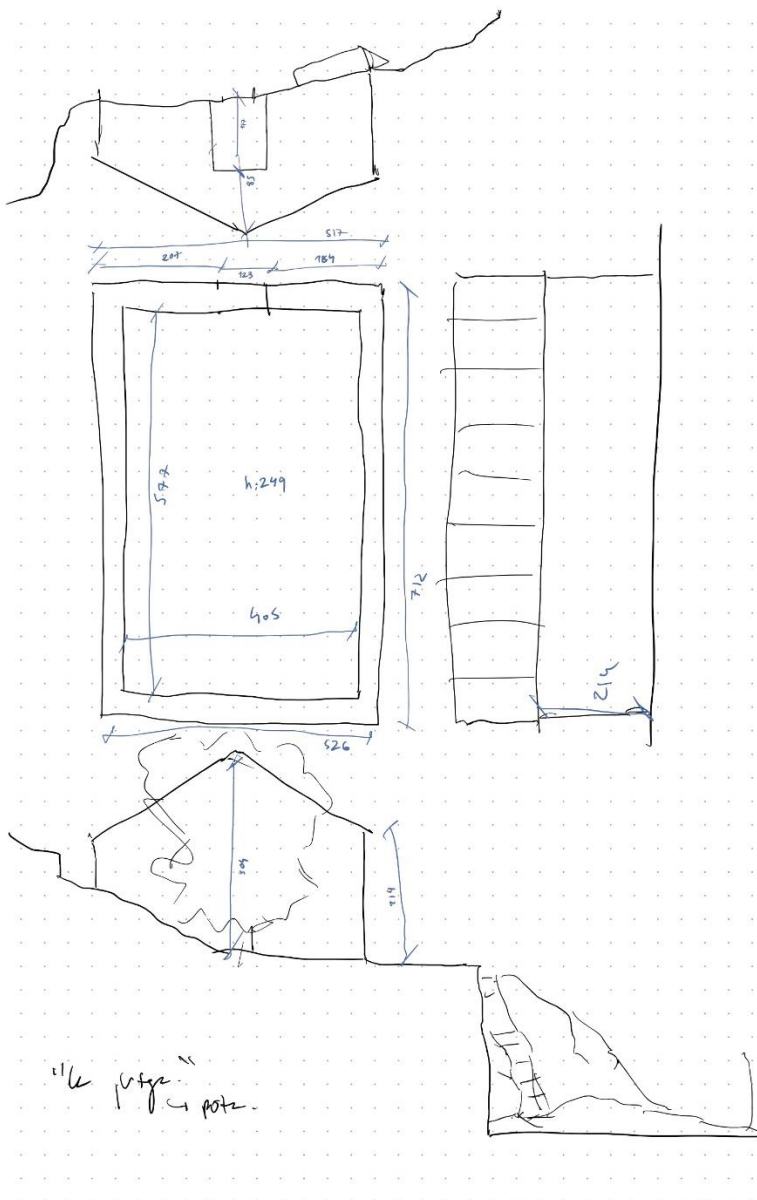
Apuntes para el levantamiento. Planta y alzados. Construcción existente 2.
